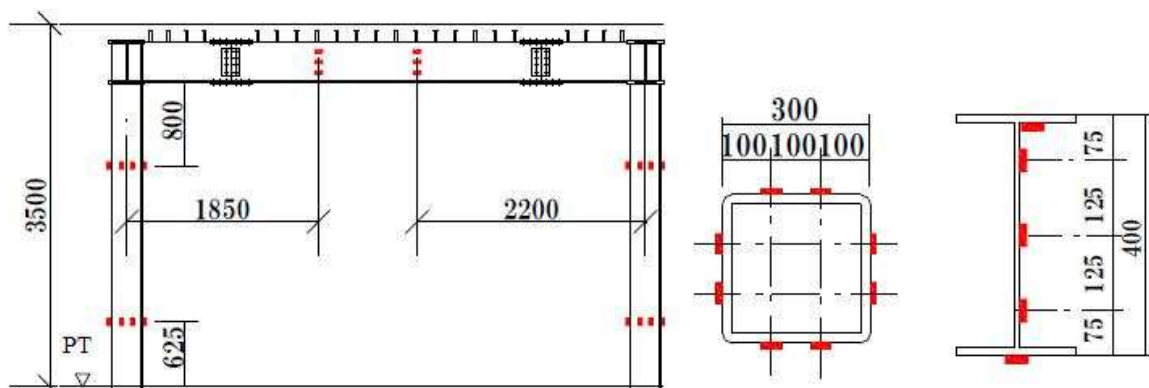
Disposição dos extensómetros nos elementos estruturais
